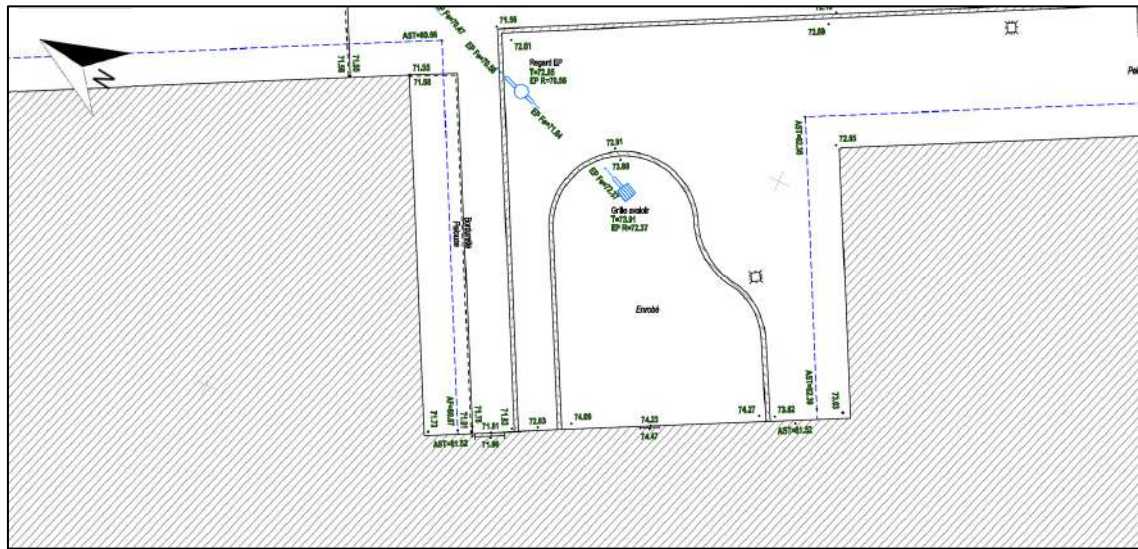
Extrait du plan topographique de la zone d'étude au droit de la terrasse
